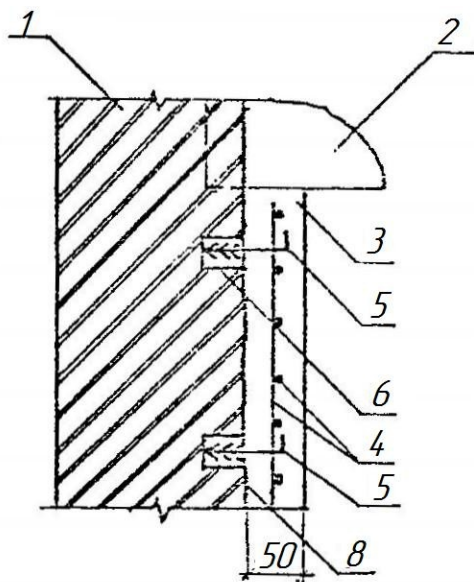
Посилення вузлів опирання балок і плит на цегляні стіни влаштуванням залізобетонної стінки:
